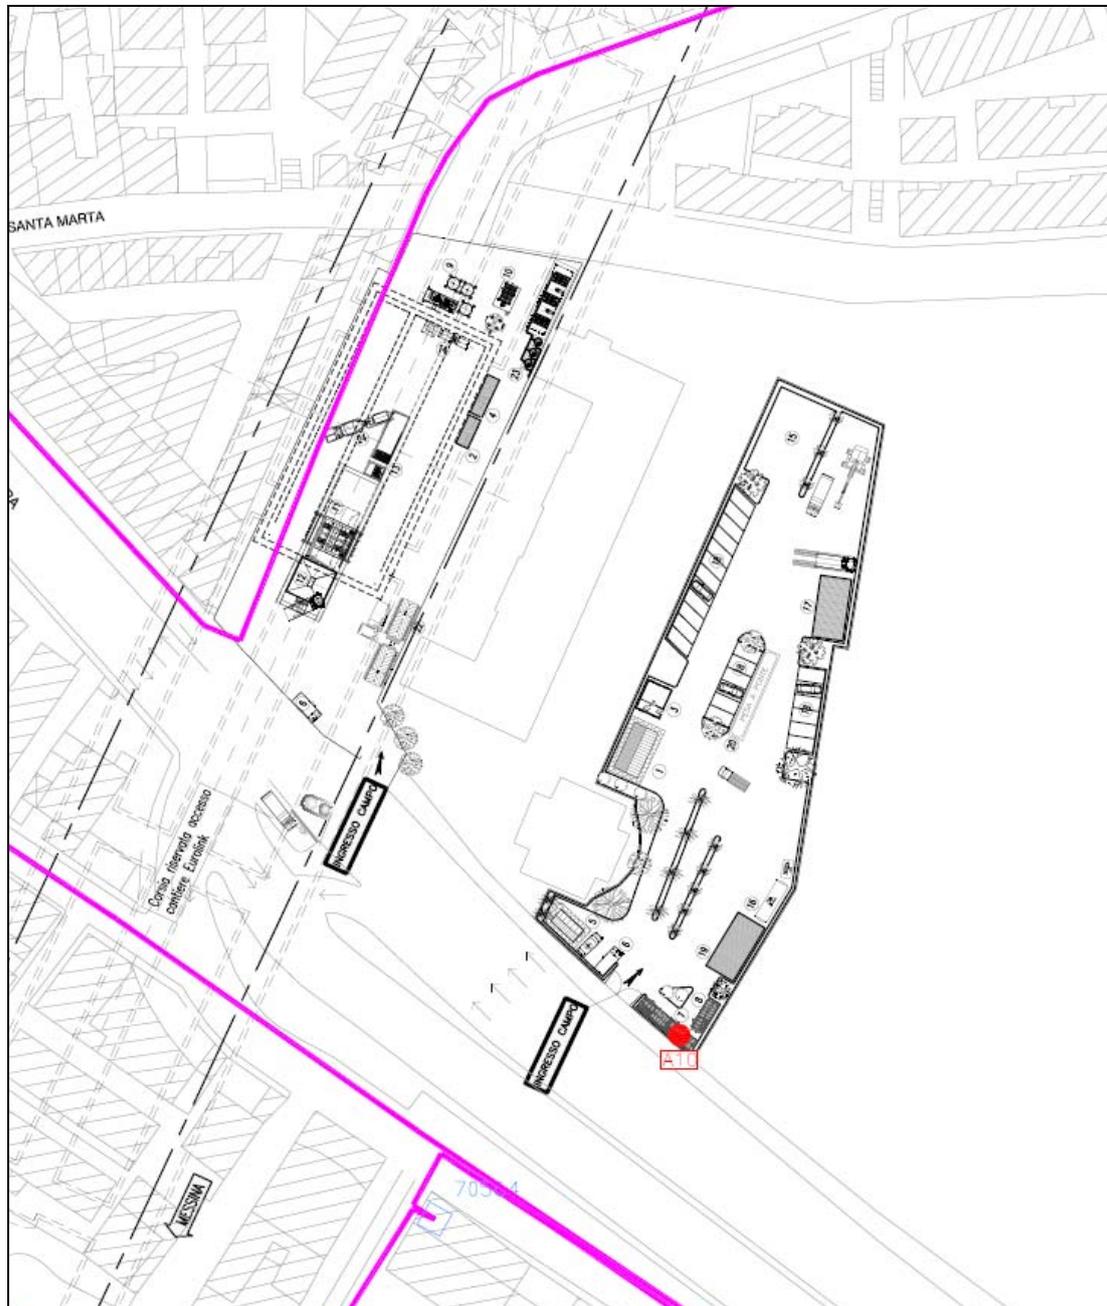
Cantiere SS3 Stazione Europa – Localizzazione punti allacciamento
